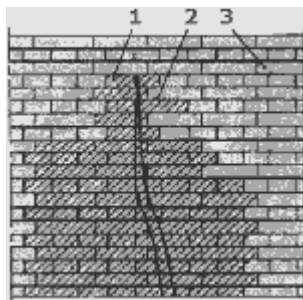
Заделка трещин в кирпичной стене: 1 - новая кладка; 2 - трещина; 3- кирпичная перемычка.
